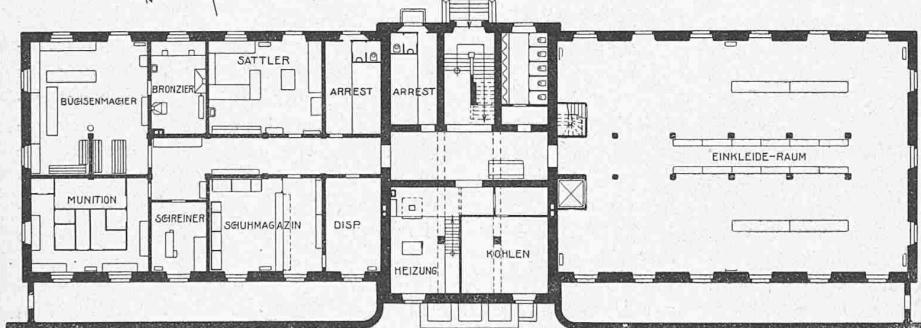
und 5. Grundrisse vom Untergeschoss und Erdgeschoss.
